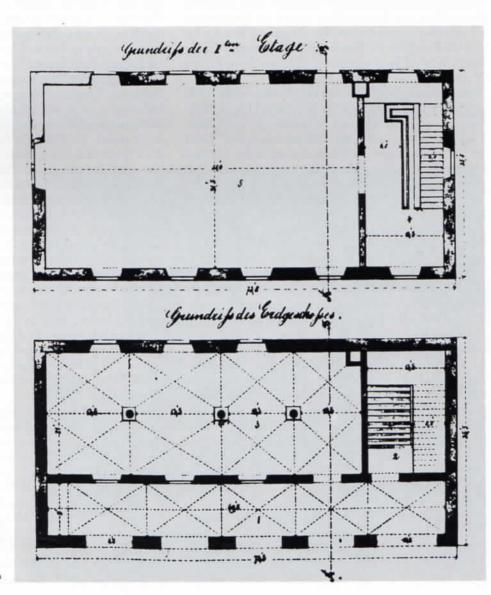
Grundrißplan des Bibliotheksgebäudes aus dem Jahre 1868.
